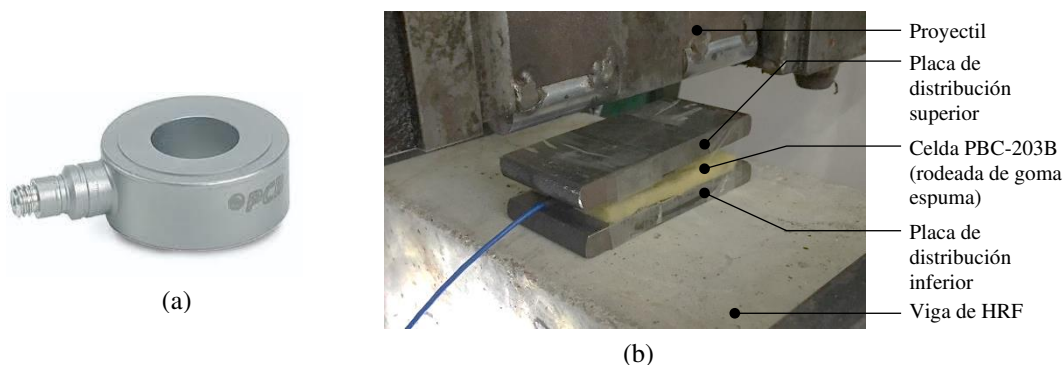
Medición de carga. a) Celda de carga PCB-203B. b) Montaje de celda de carga con placas de distribución.
